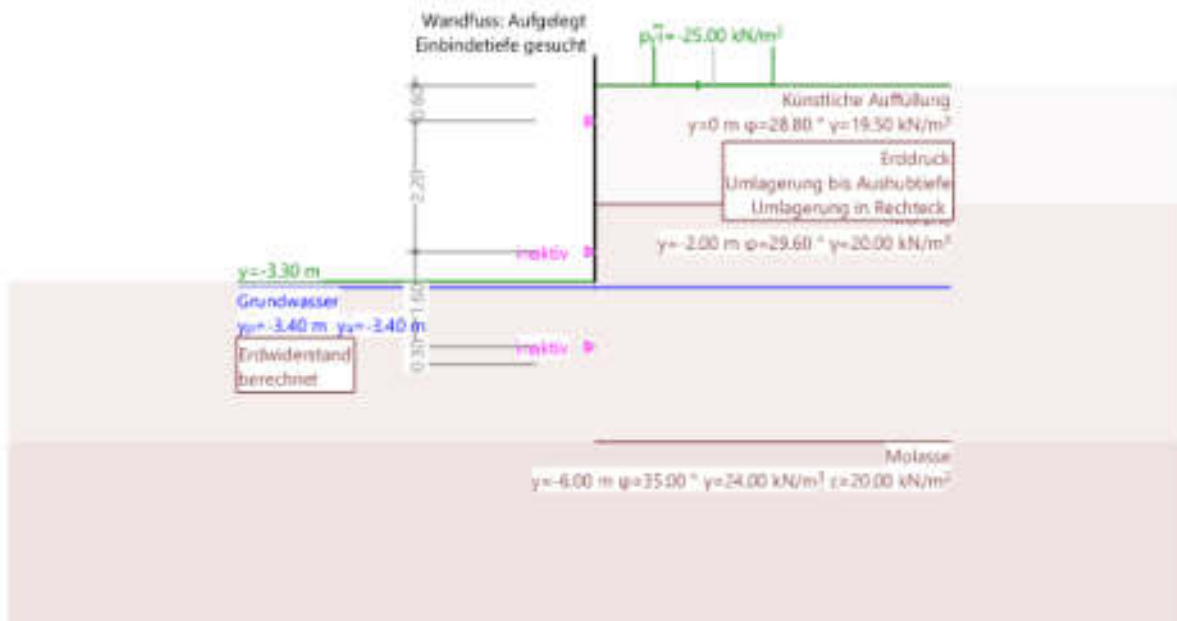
Baugrube vor Einbau 2. Spriesslage
